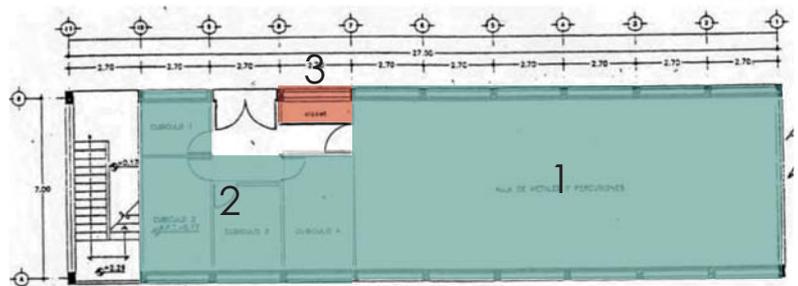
PLANTA METALES Y PERCUSIÓN, PLANTA BAJA.
